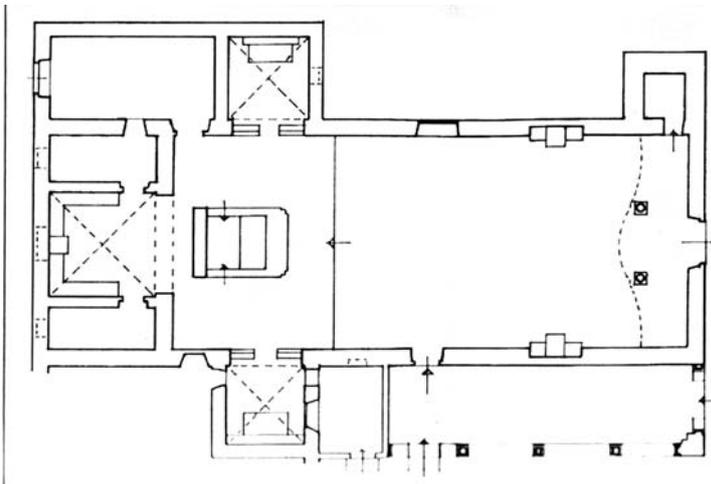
Pieve dei santi Vincenzo e Pietro - pianta redatta da G.Melani
